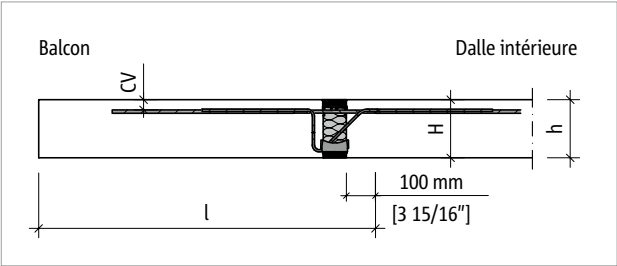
Schöck Isokorb® T Type CK : système structurel
